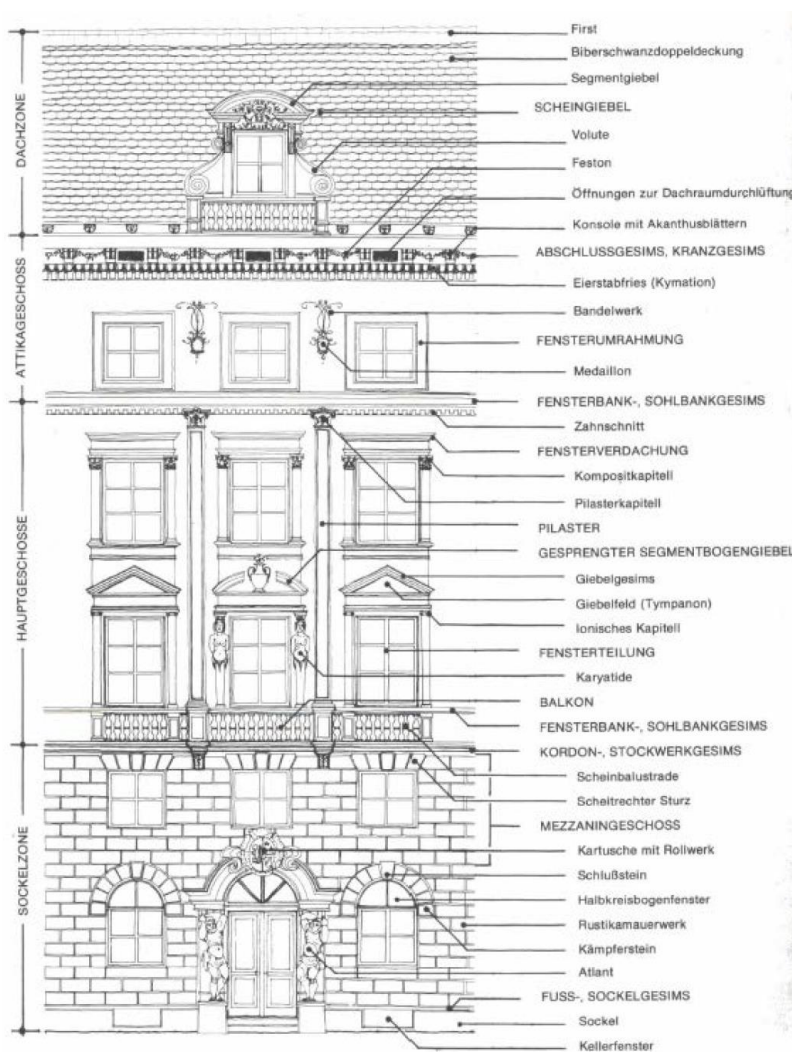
Typische Fassadengestaltung eines Gründerzeithauses⁵⁴
